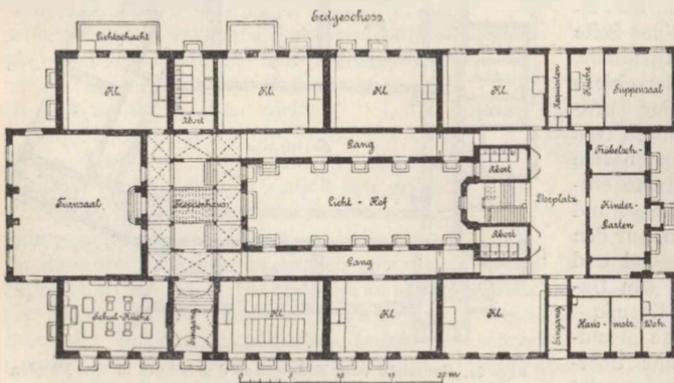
Grundriß vom Erdgeschoß der Volksschule in München-Neuhausen.
